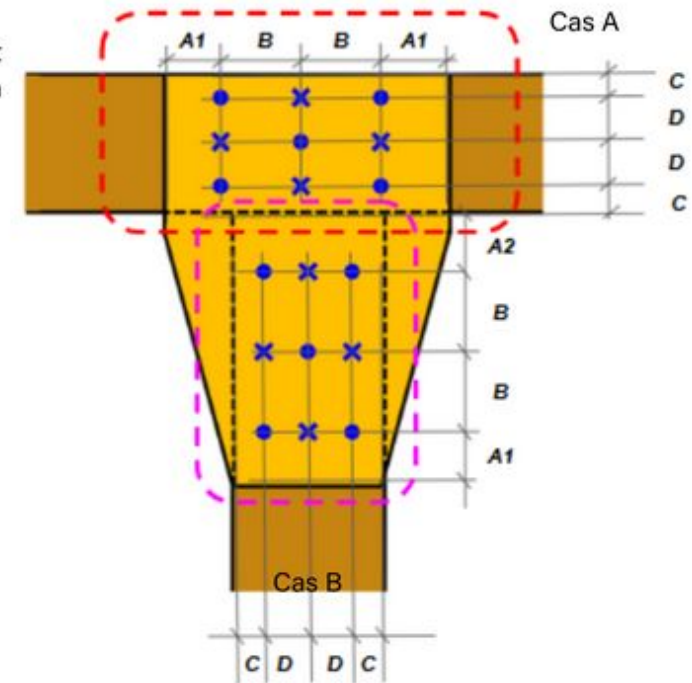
Détail de clouage des plaques d'assemblages des ferme
